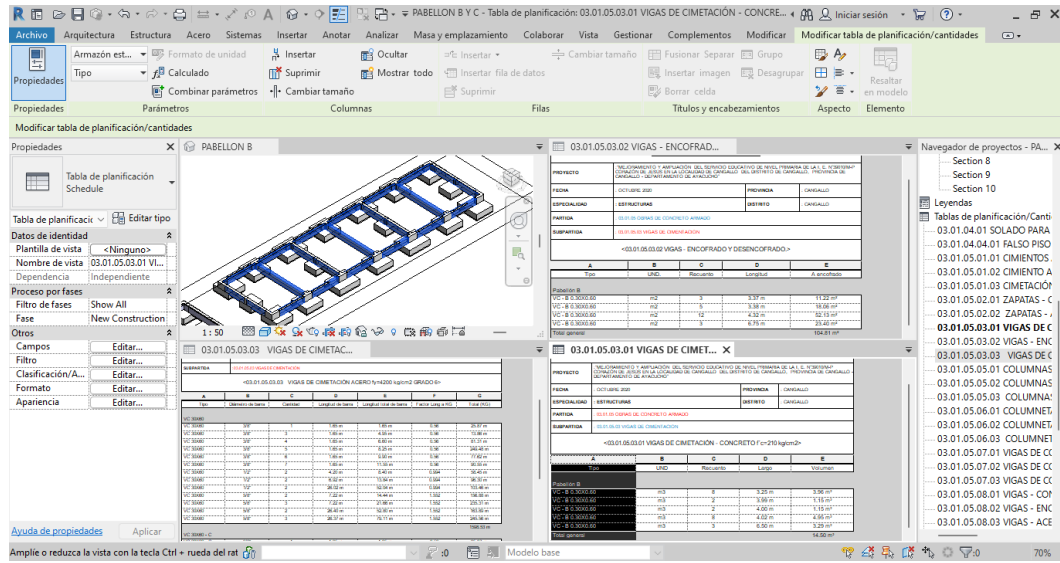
Modelado y metrados de la partida Vigas de cimentación Modulo B y C.
